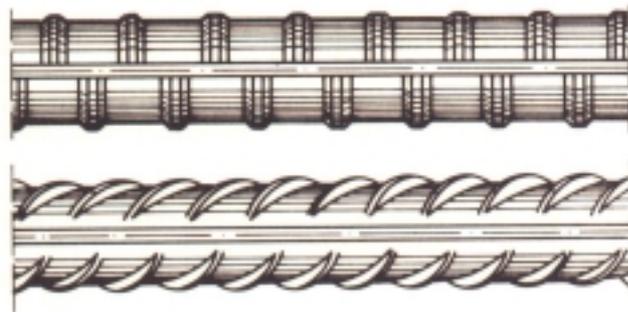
Barras de aço para Concreto Armado (Ref. 1)
